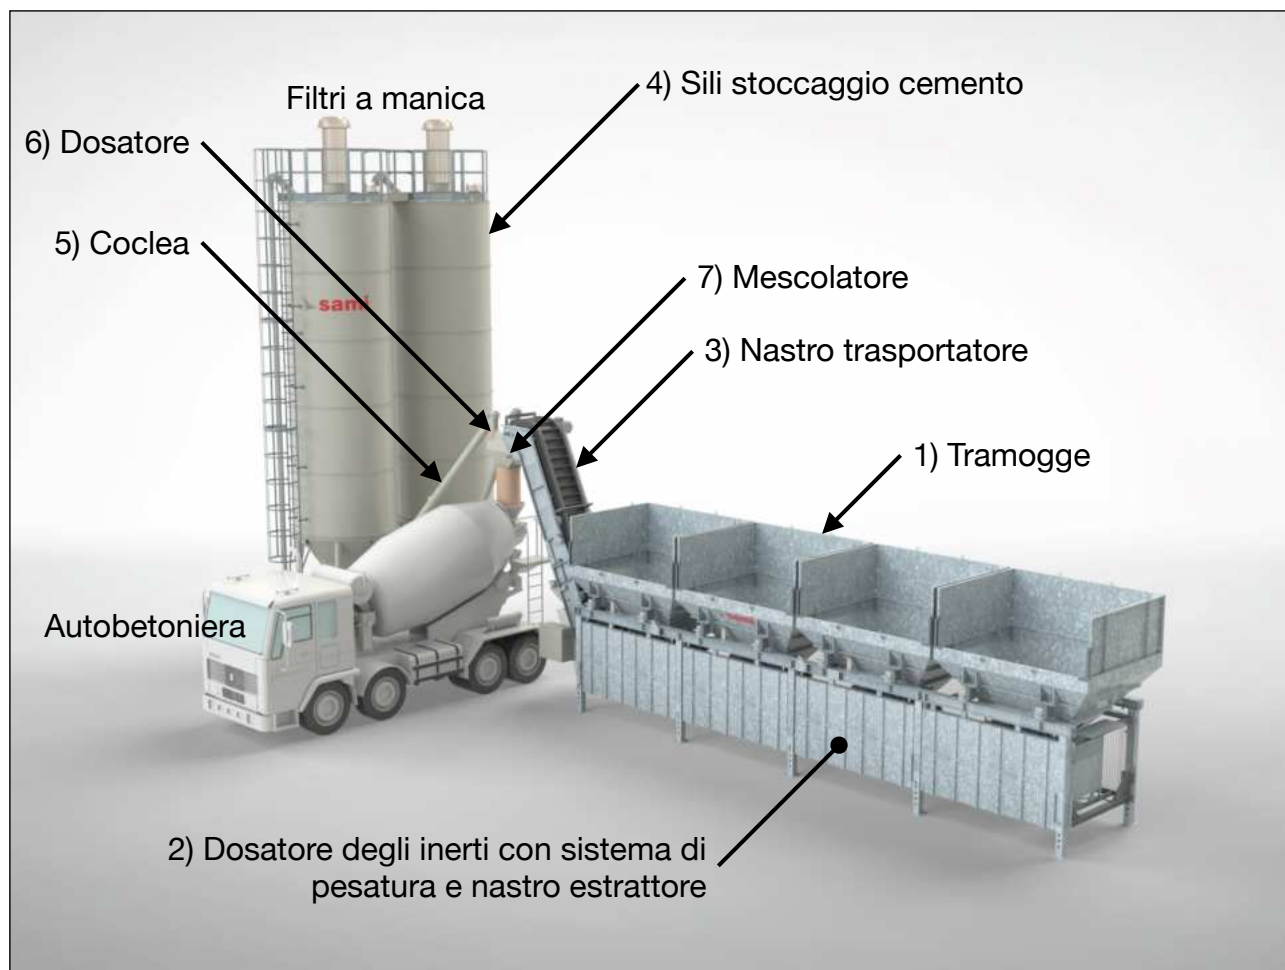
Componenti tipo di un impianto di betonaggio (fonte: Sami Srl)
